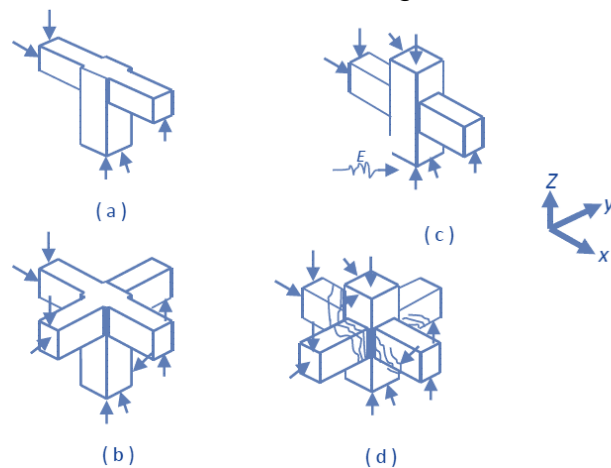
Gaya dan Penulangan Geser pada Joint Balok-Kolom
